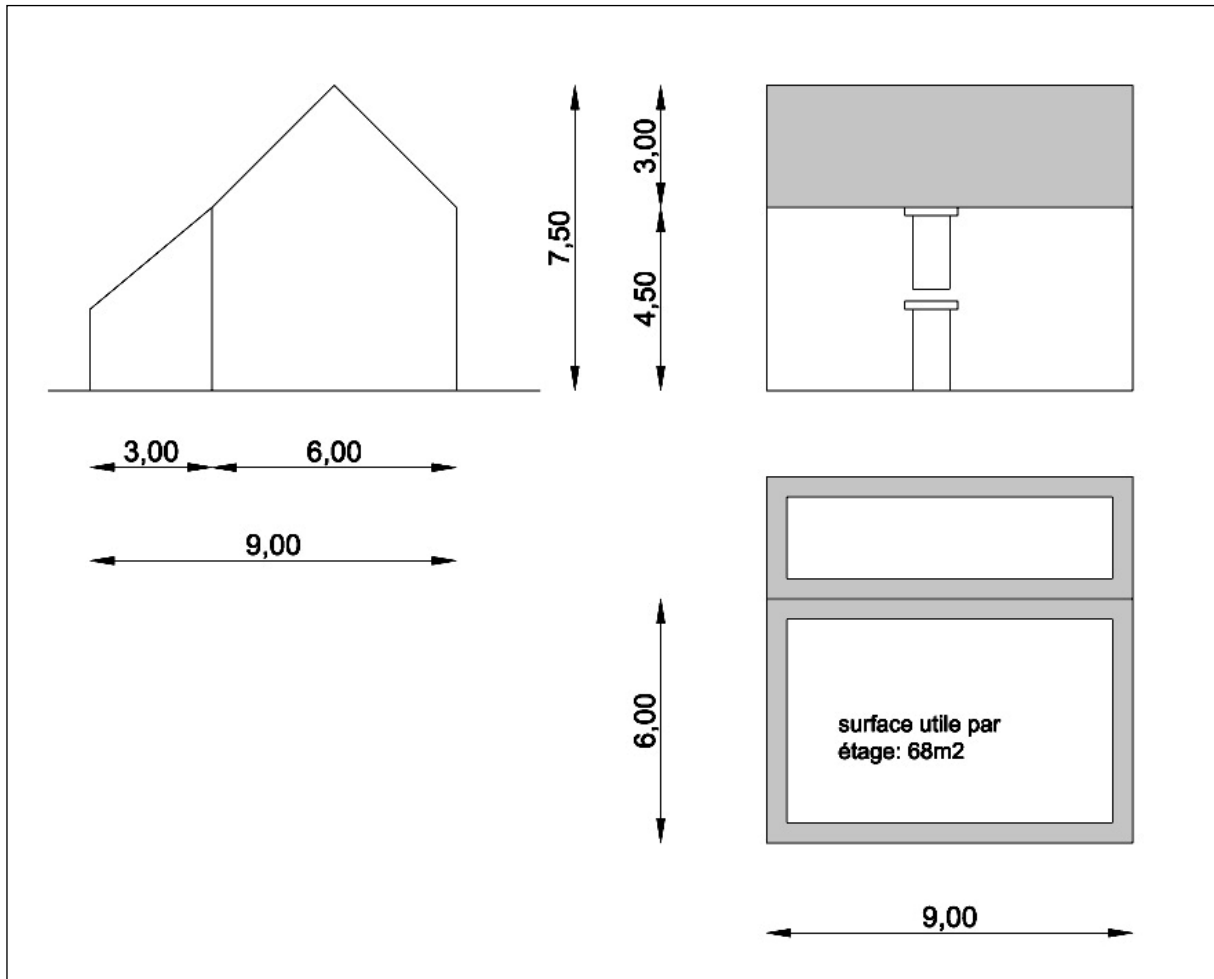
plan de coupe, rapport entre le bâtiment existant et les annexes futures.
